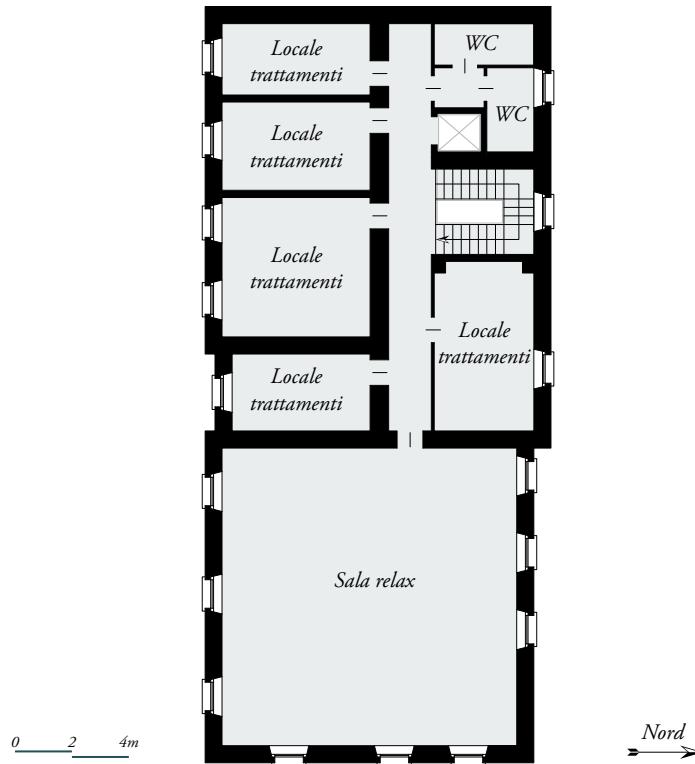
Hotel Paradiso, planimetria di progetto piano secondo (fuori scala).
